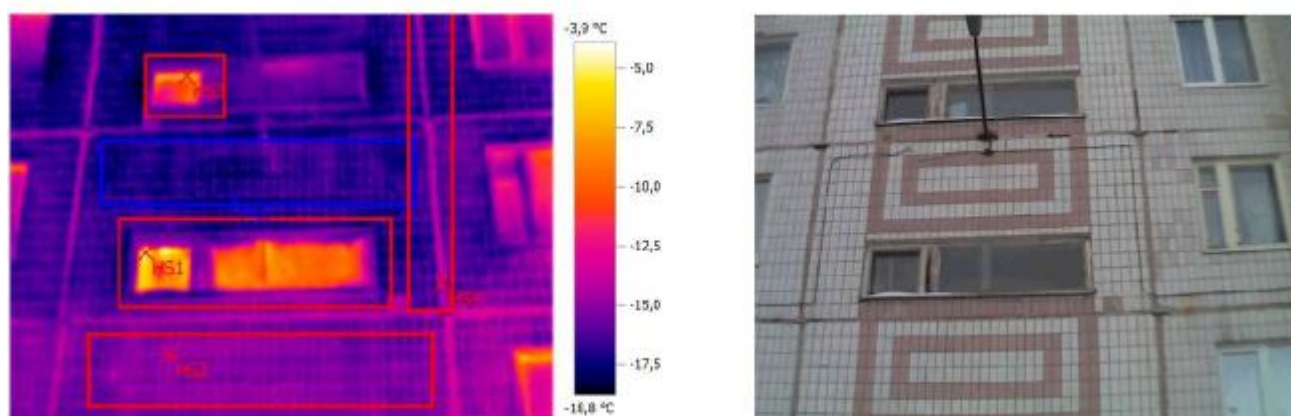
Тепловизионное и реальное изображение фасада здания.
